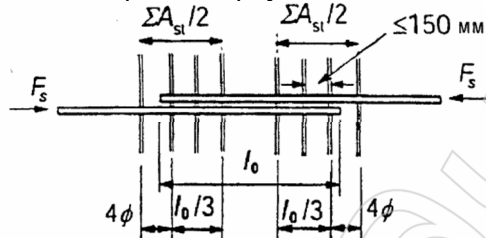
Поперечне армування для з'єднання внапуск стержнів
